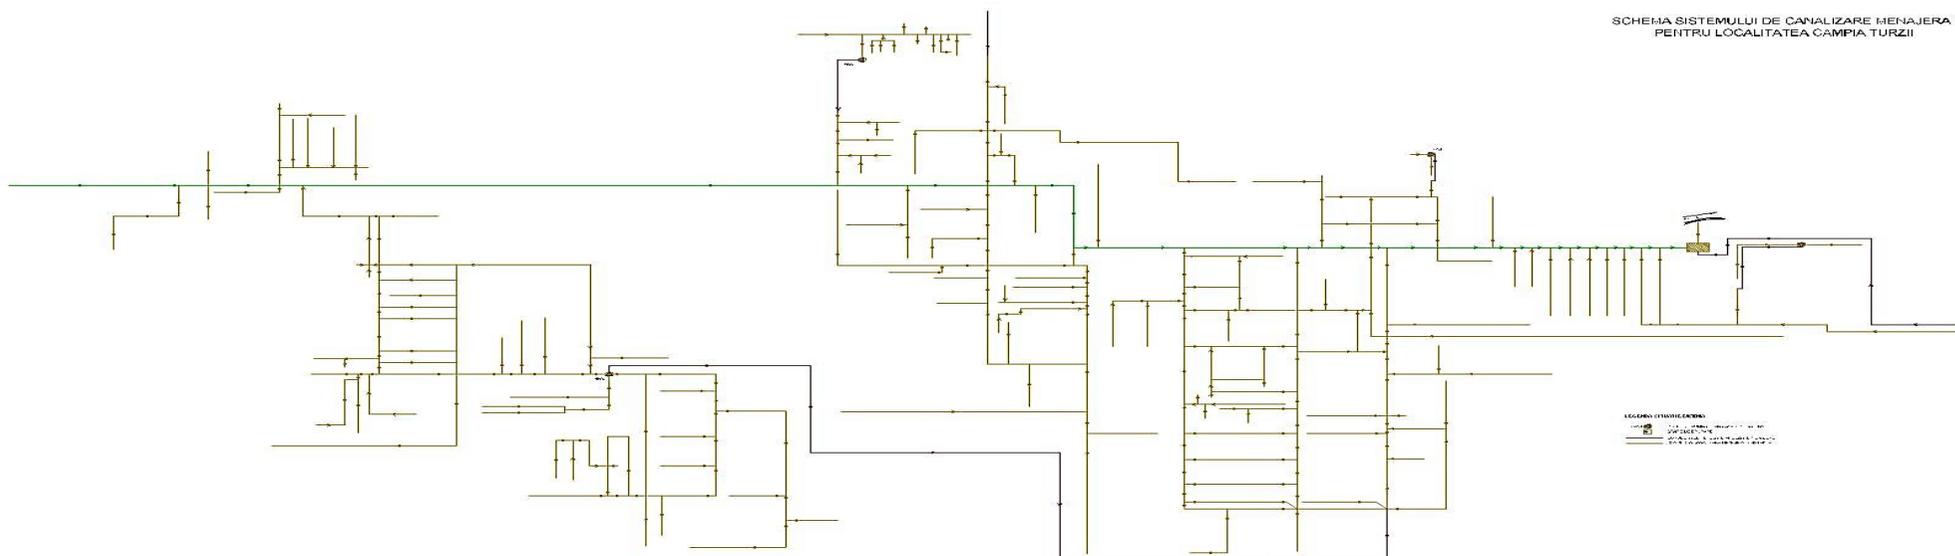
Schema sistemului de canalizare Campia Turzii
